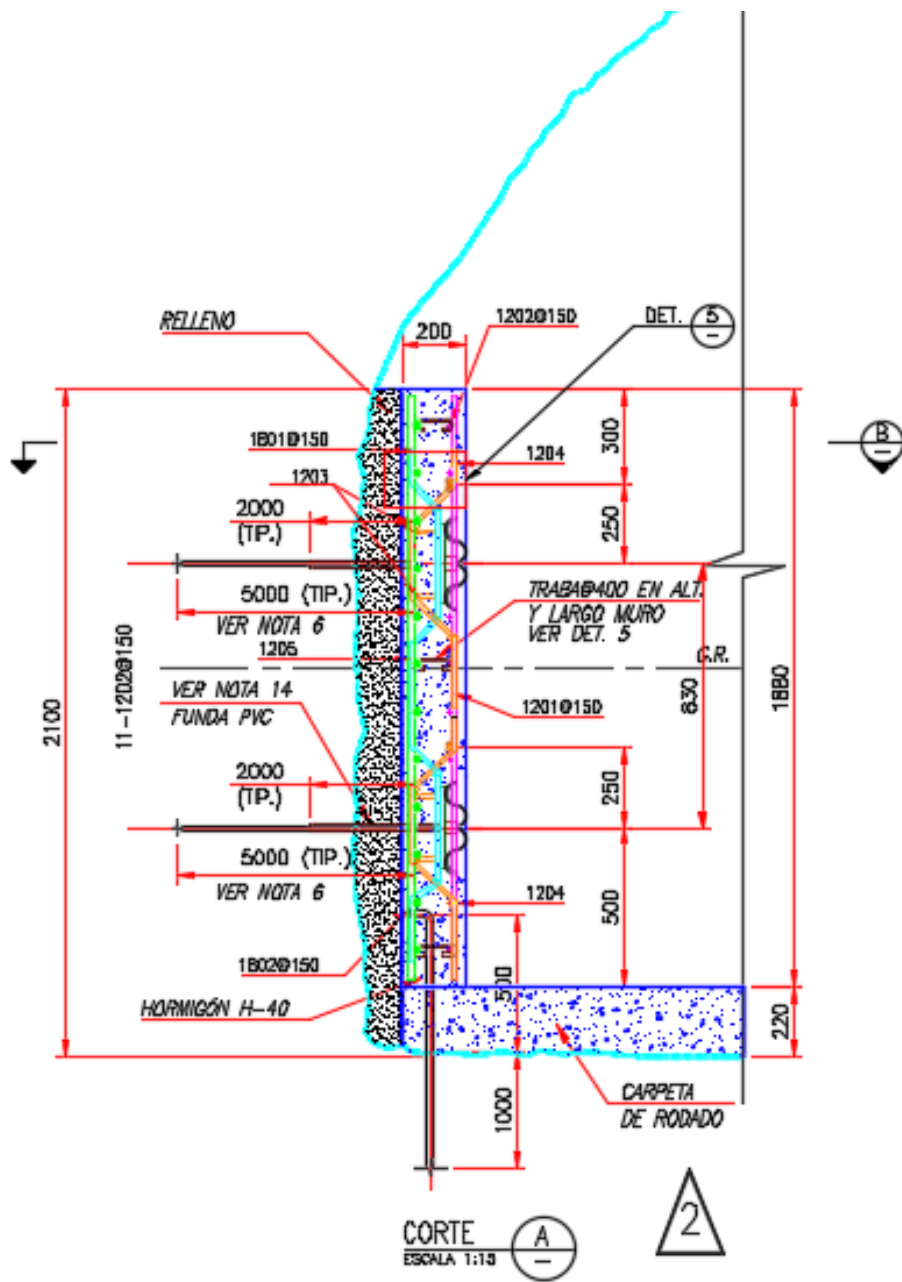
Diseño Muros de fortificación pilares para Esmeralda y Reservas Norte
